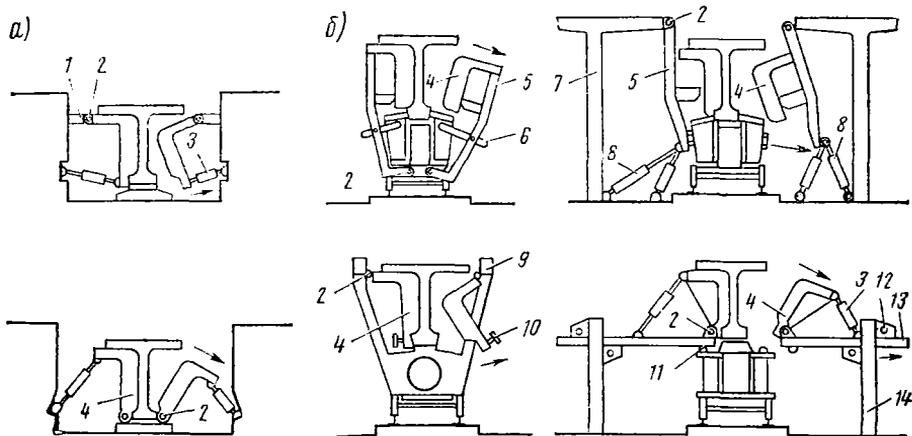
Схемы механизированно раскрывающейся опалубки для стендов: а — стационарных, б — передвижных; 1 — кронштейн; 2 — шарнир; 3 — винтовая стяжка; 4 — щит опалубки; 5 — рычаг; 6 — винтовой механизм; 7 — эстакада; 8 — гидропривод; 9 — верхняя распорка стенда; 10 — упорный винт; 11 — съемный болт; 12 — ролик; 13 — передвижная балка; 14 — столб
